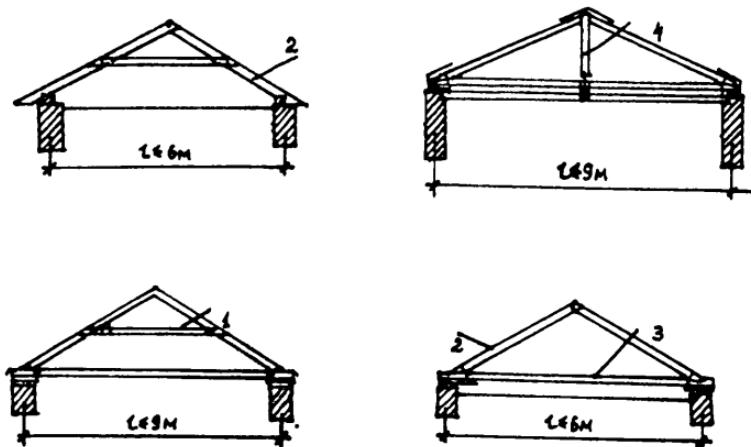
Схемы скатных крыш с деревянными висячими стропилами:
